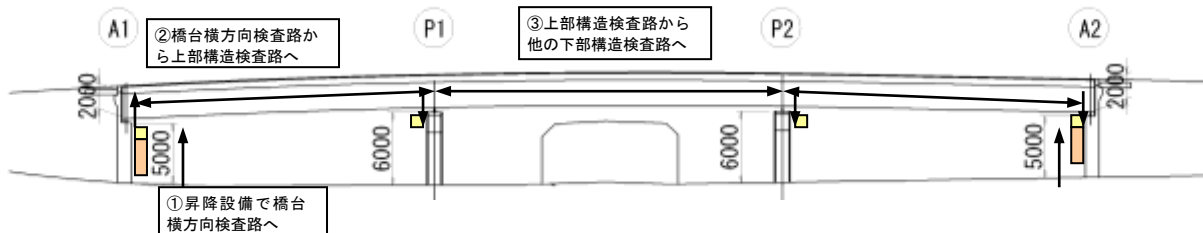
3径間連続鋼桁橋（跨道橋）の検査路設置計画例
